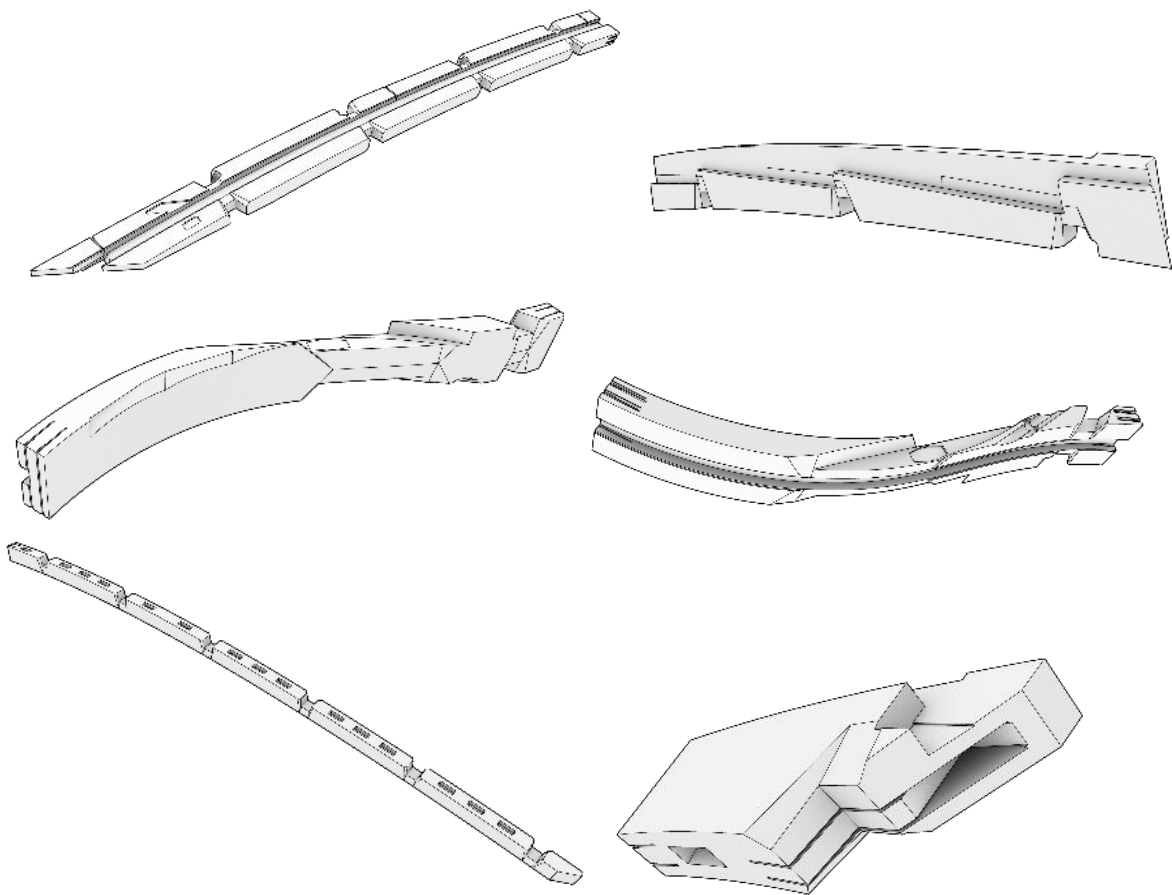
Die Vielzahl an Verbindungsdetails und Installationsausschnitten führt zu einer breiten Palette ungewöhnlich detaillierter Holzbauteile
